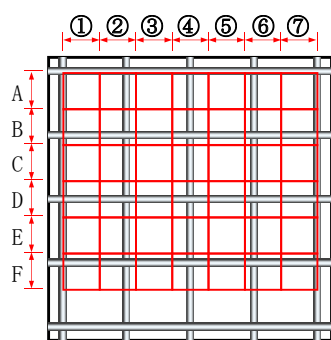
損傷したコンクリート梁模擬試験体の測定位置
